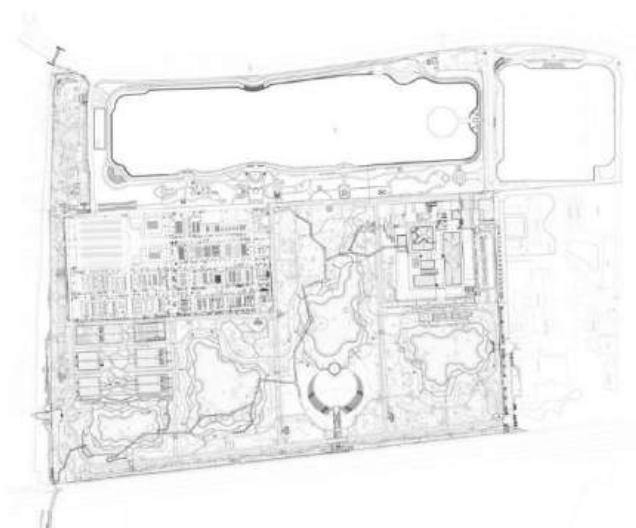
Генплан Benjakitti Forest Park [39]
